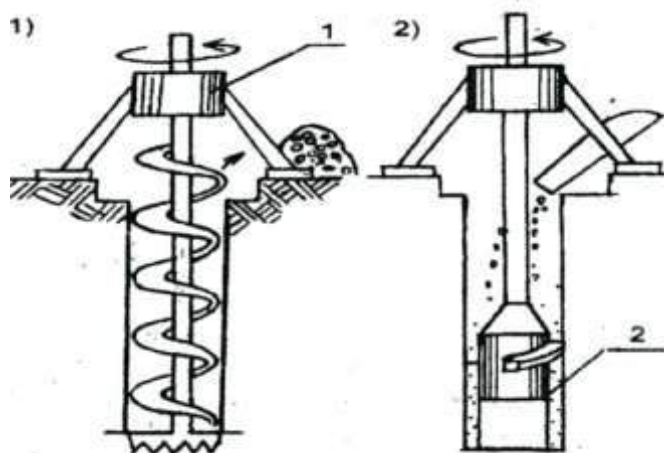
Змінні насадки. 1 - бурова насадка, 2 – пресуюча насадка.
